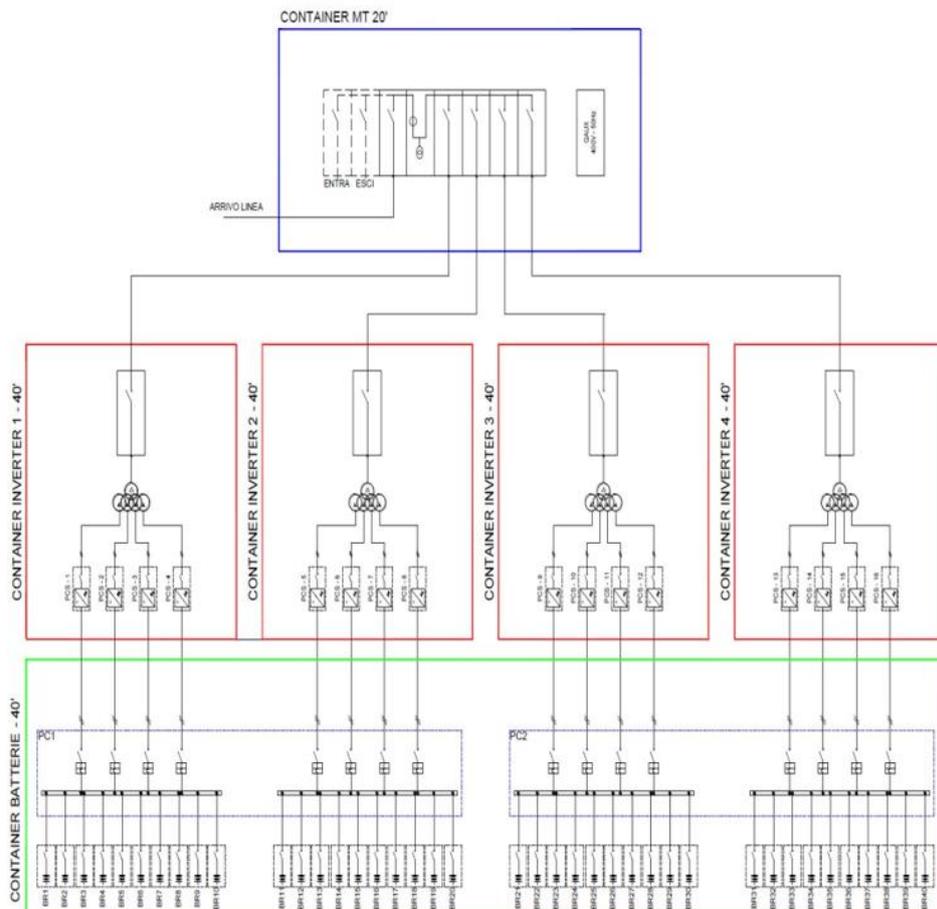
Esquema unifilar de disposición de las baterías. (Ficha técnica fabricante).
